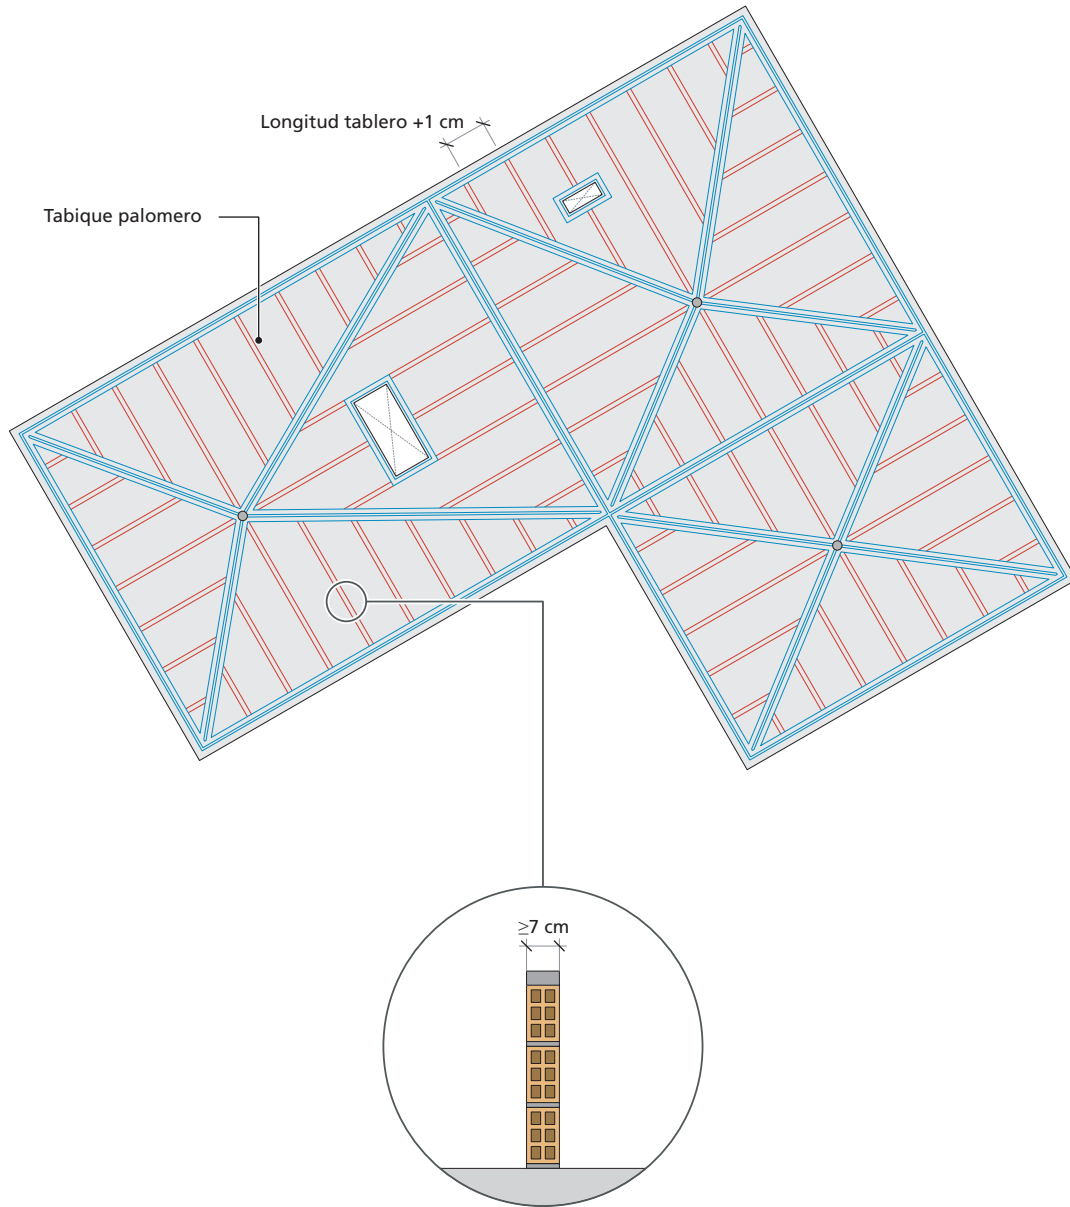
Replanteo de limahoyas en cubierta plana sobre forjado
